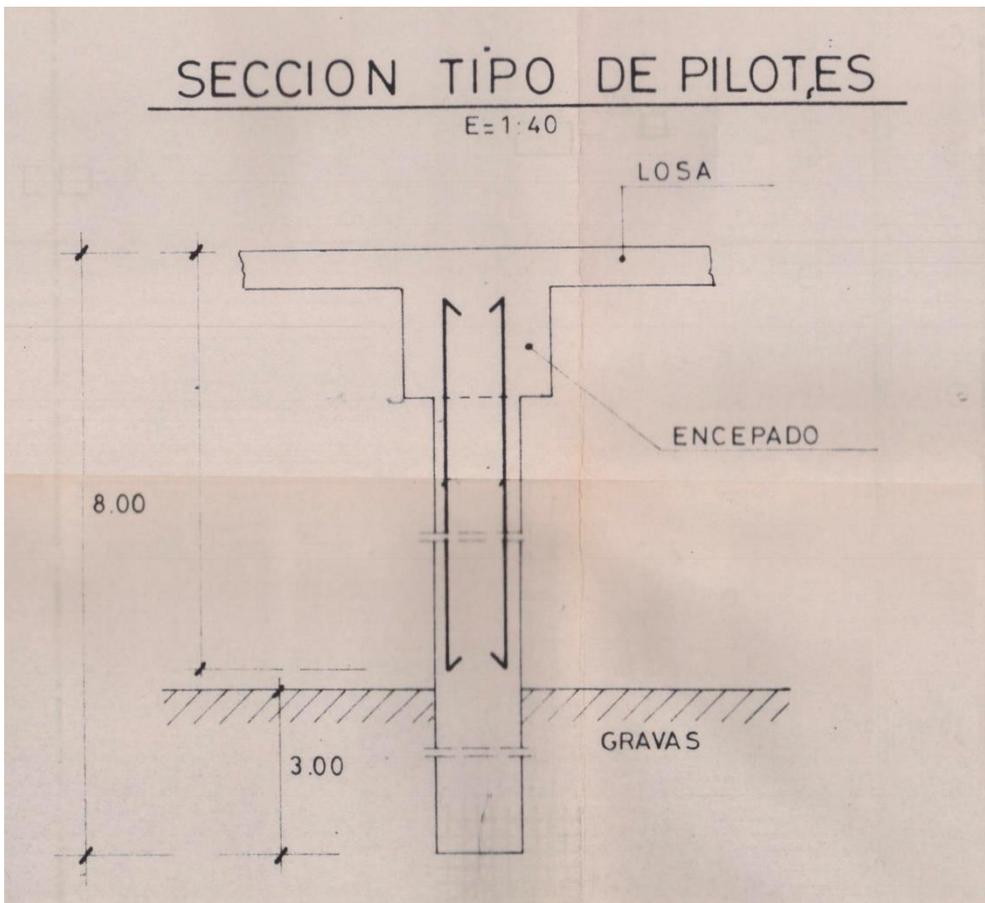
Detalles constructivos de pilotes. Fuente: Archivo personal de Cortés
